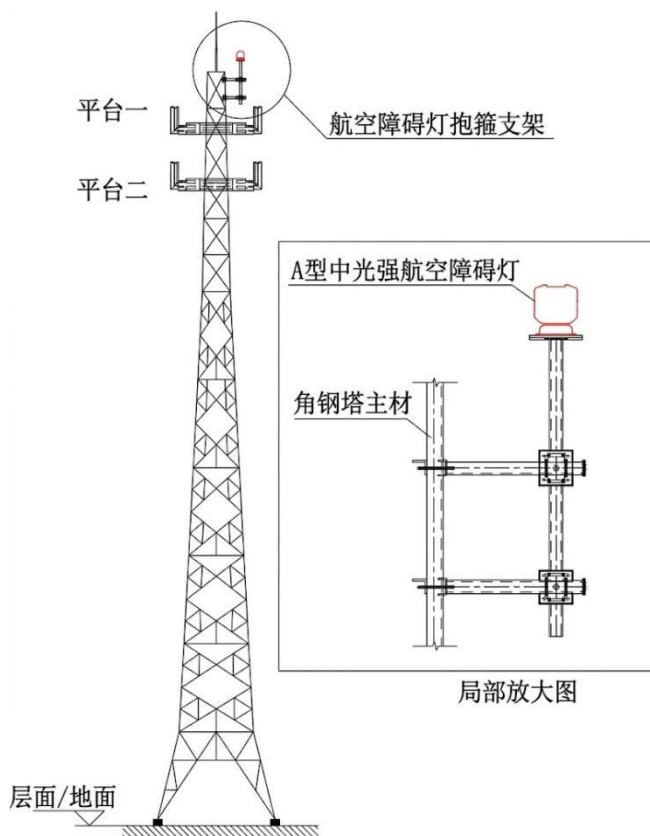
角钢塔设置航空障碍灯支架立面图
